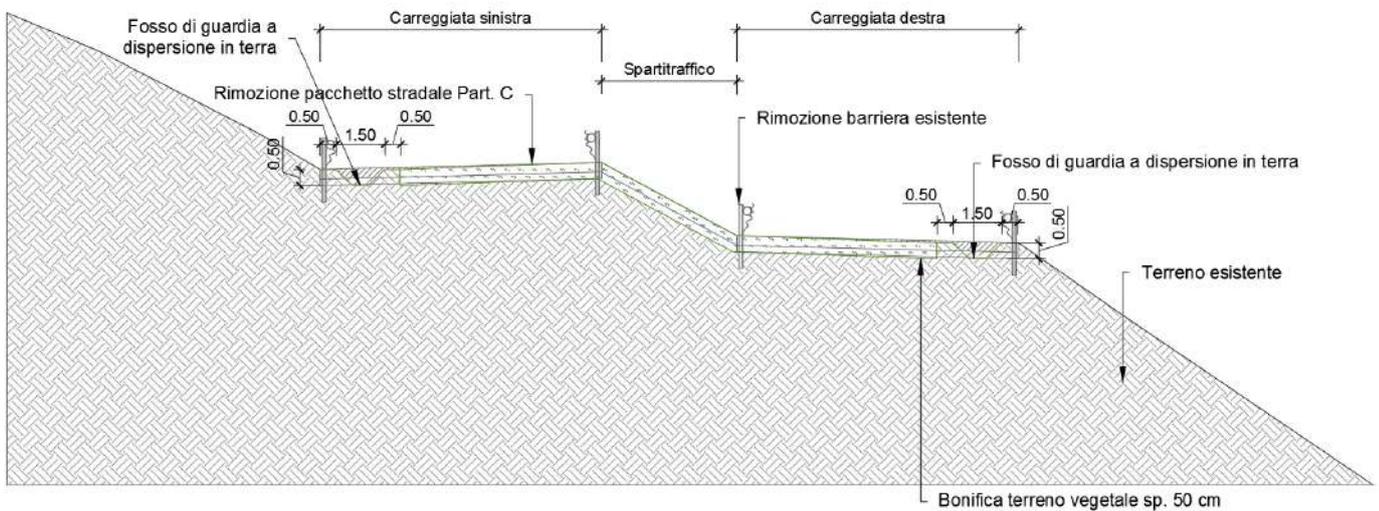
Sezione tipo A_4 riprofilatura tratto a mezza costa sfalsata
